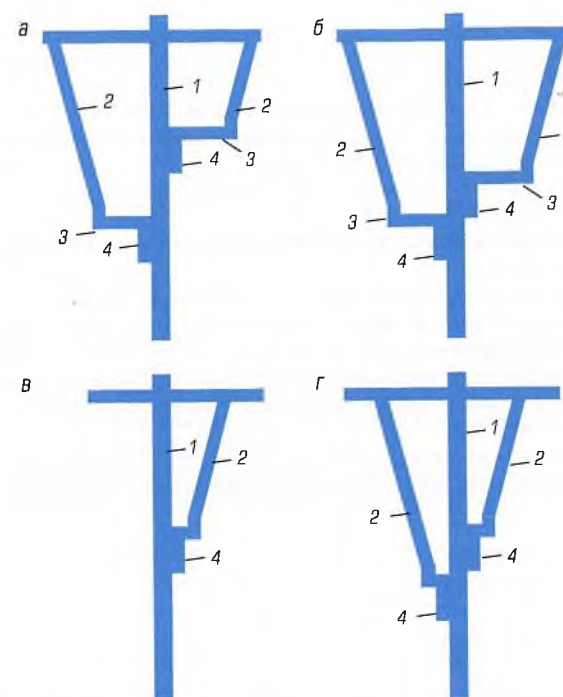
Комплекс камер загрузочного устройства скипового подъема:
